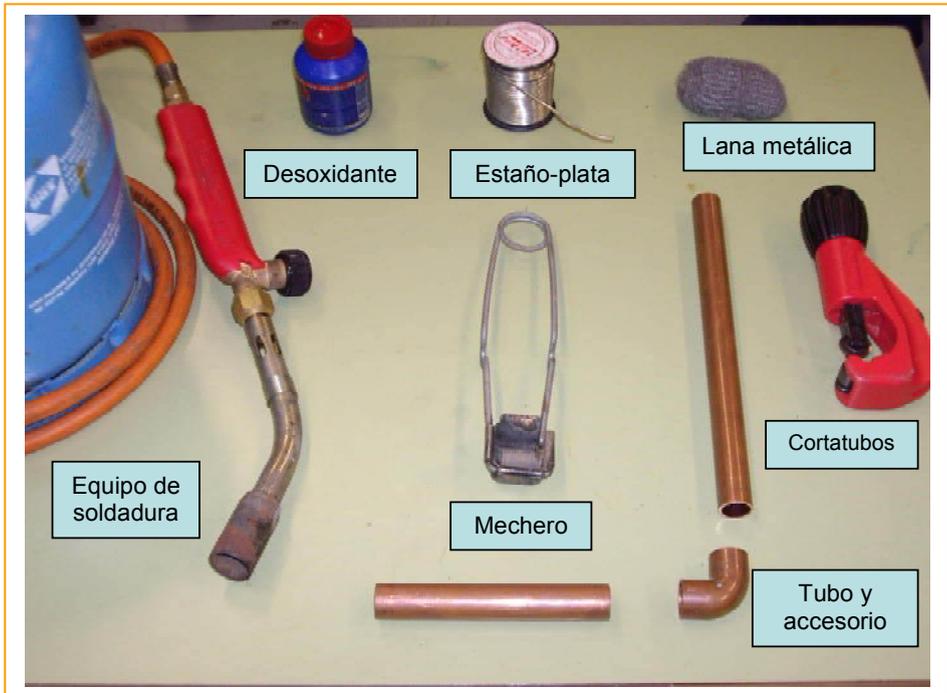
Materiales que intervienen en la soldadura blanda.
